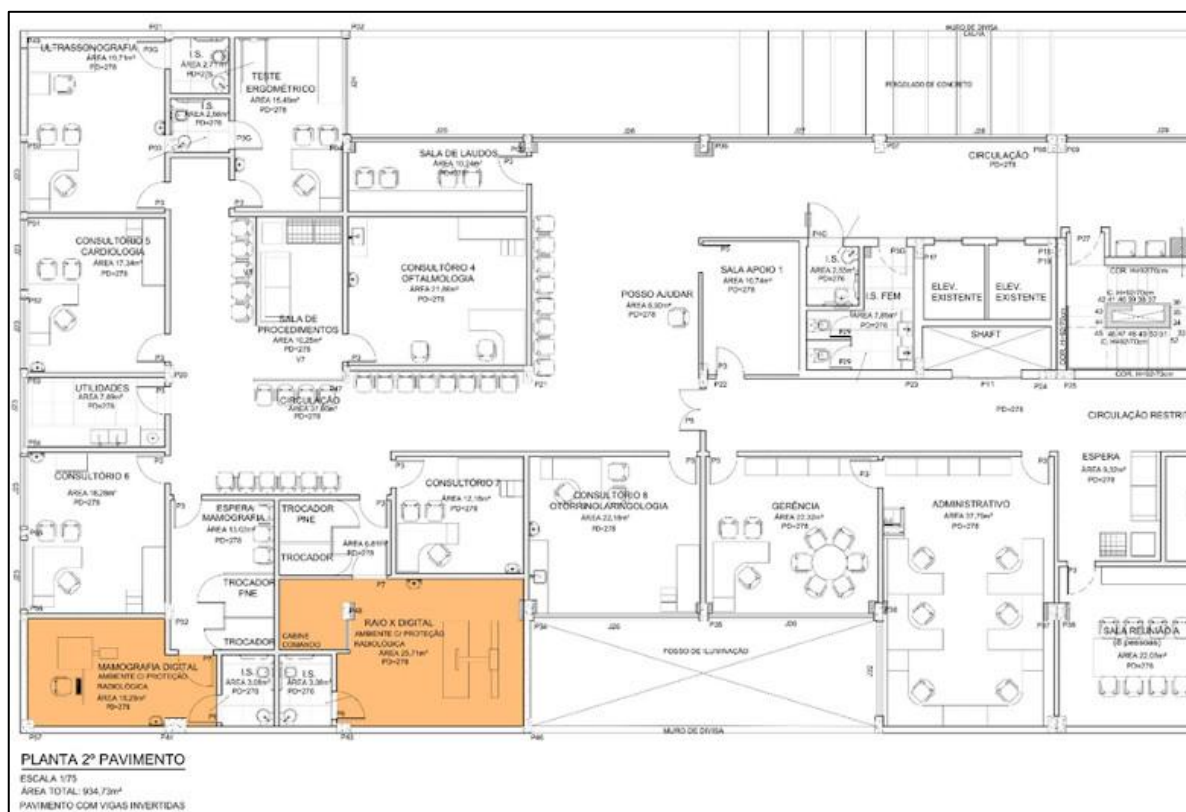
Planta 2º pavimento – salas de mamografia e raio-X digitais.
